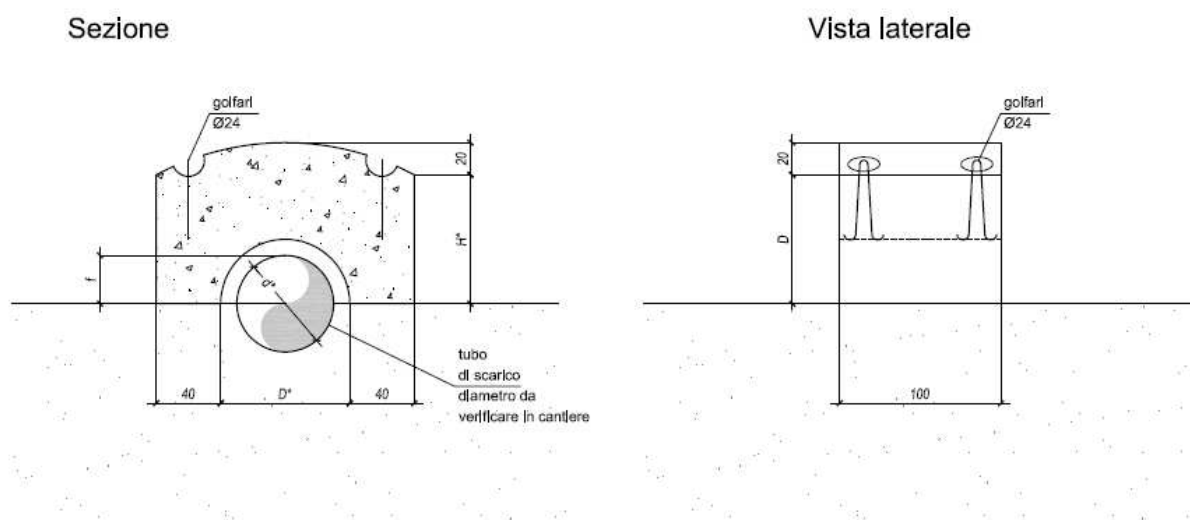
Dettaglio tipico della protezione in calcestruzzo del tubo di scarico di emergenza
